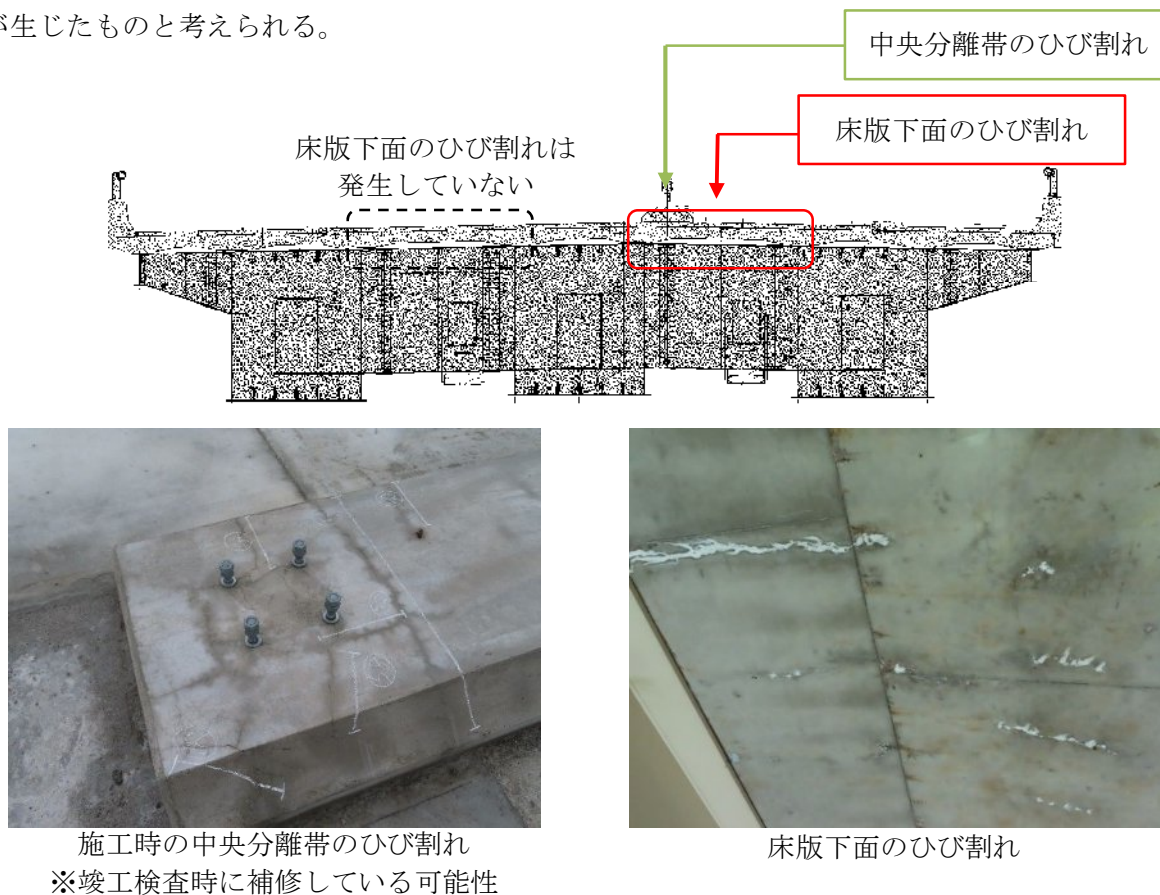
中央分離帯下の床版のひび割れ事例
